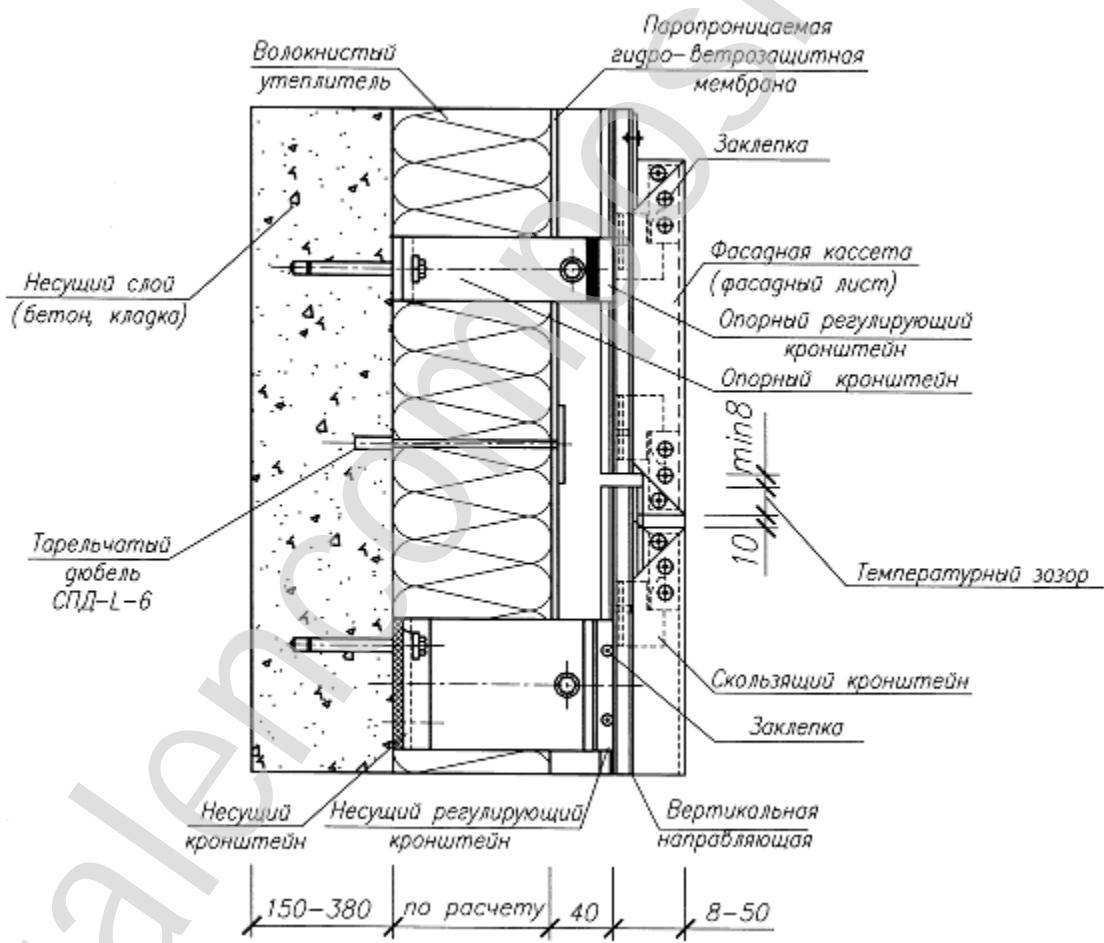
Конструкция навесного фасада с размещением утеплителя и тарельчатых дюбелей.
